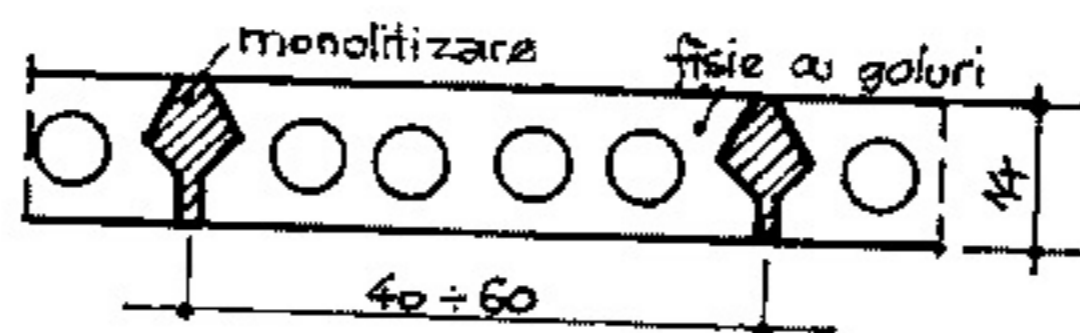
Fâșii din beton armat cu goluri rotunde
